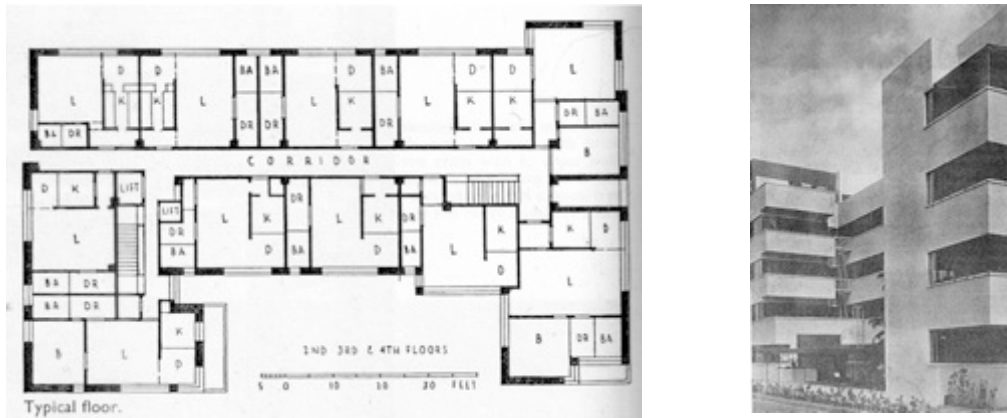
Planta General y Fachada - Garden Appartments. Fuente: F.S. Yorke
